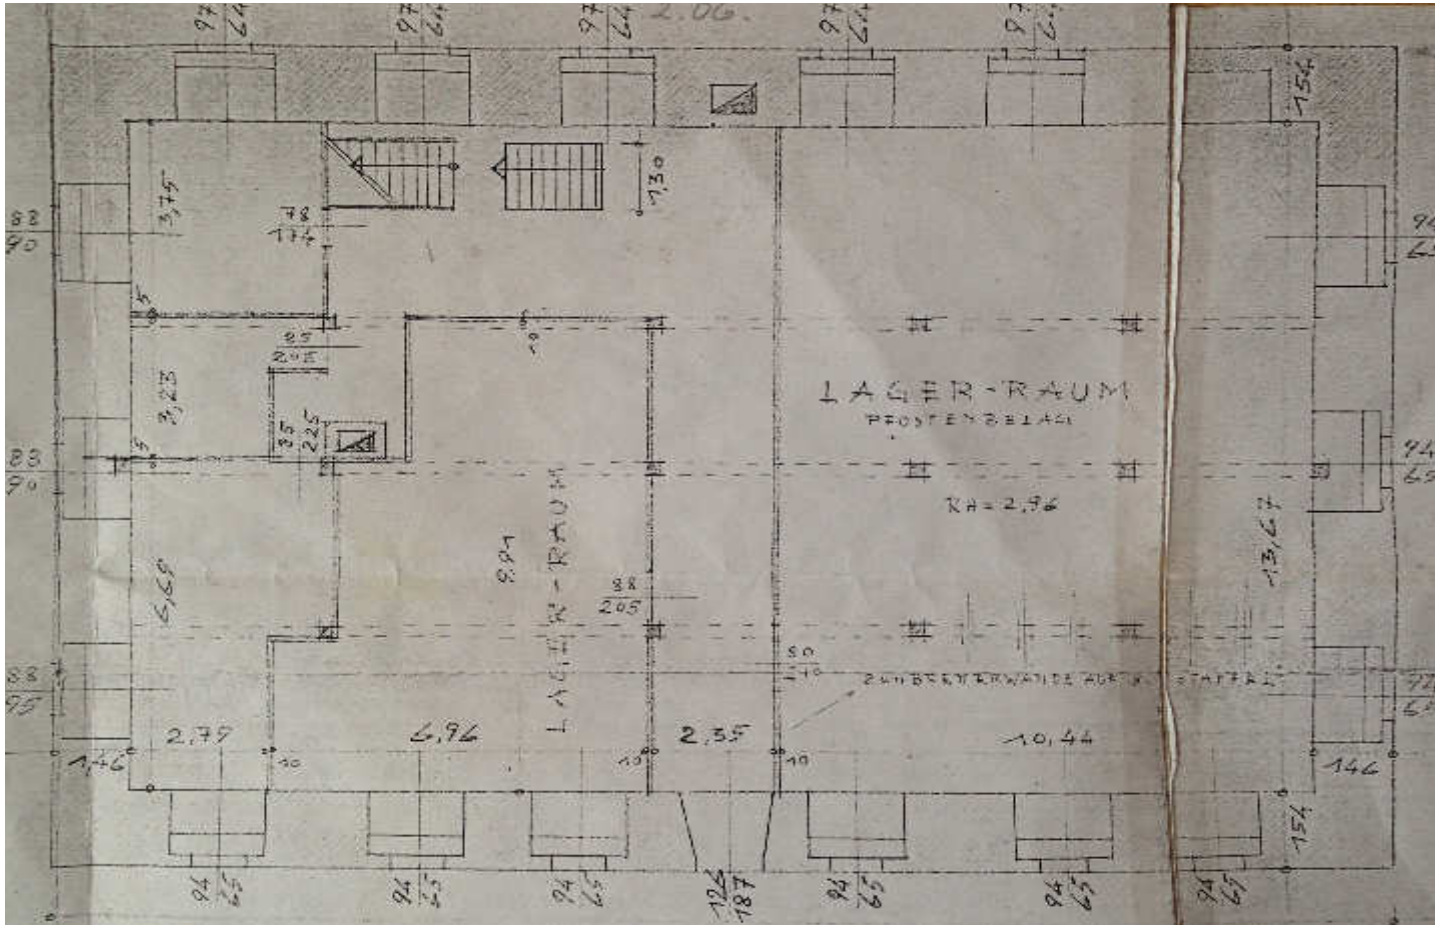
Bestandsplan 1959 - Grundriss zweites Speichergeschoss
